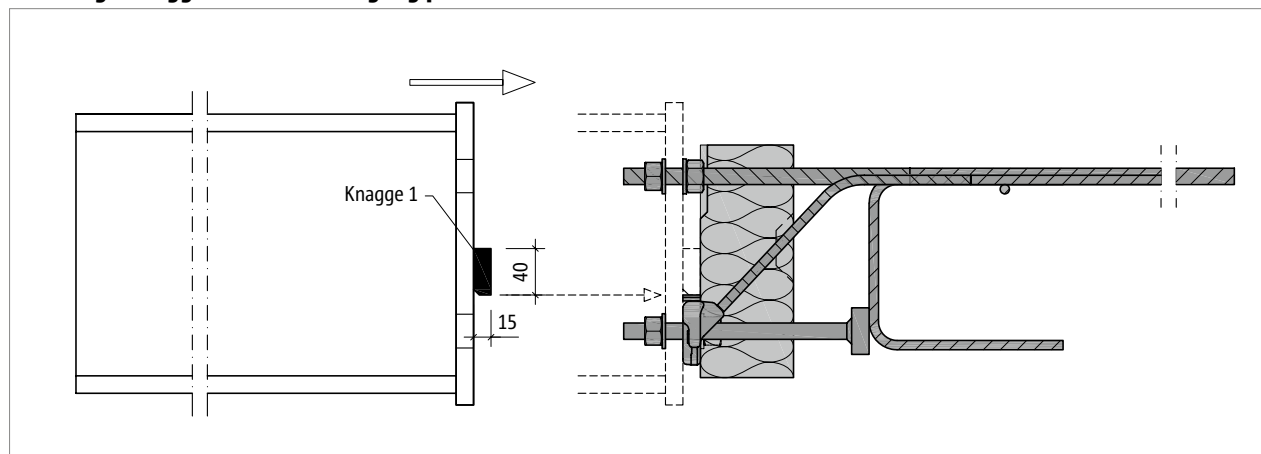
Schöck Isokorb® T Typ SKP: Montage des Stahlträgers
